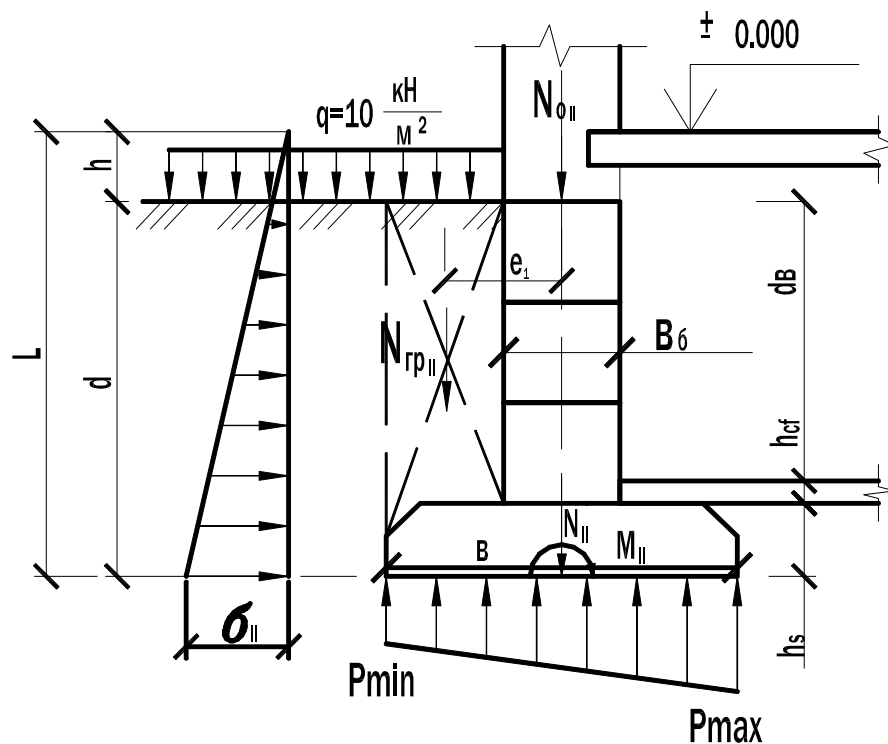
Расчетная схема ленточного фундамента под стену при наличии подвала
